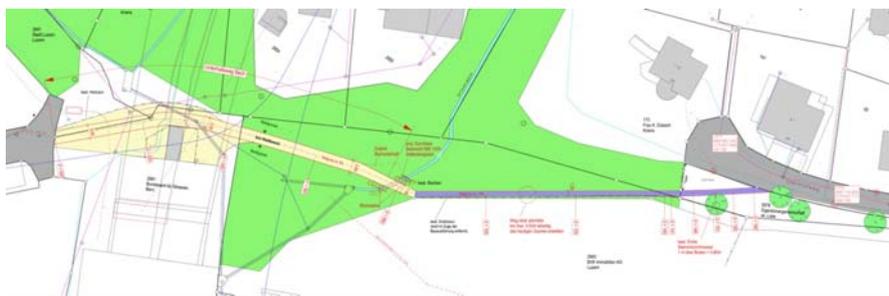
Ausschnitt Situationsplan „Öffentlicher Fussweg Amstutzweg - Steinhofweg, 6010 Kriens“, Entwurf vom 05.11.2010
